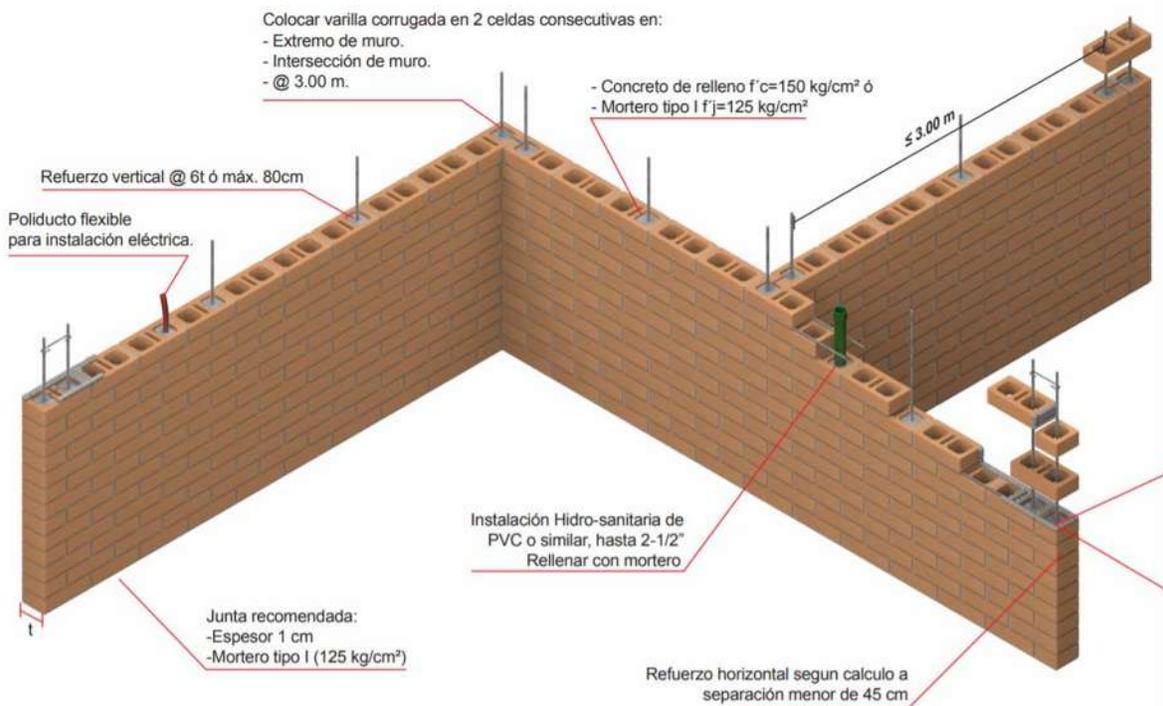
Sistema constructivo de muro aparente con refuerzo interno. Novaceramic.
